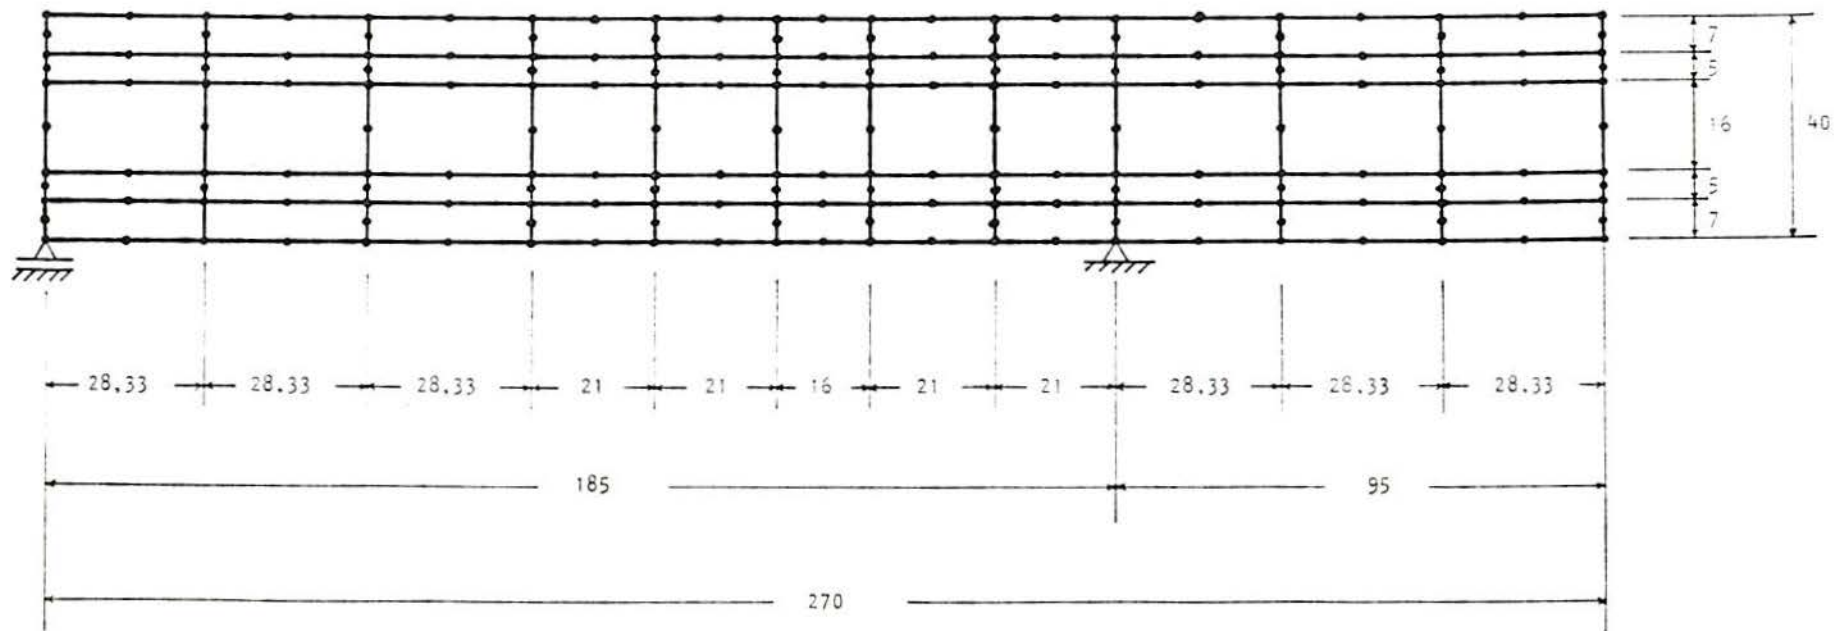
Discretização das vigas para a análise por elementos finitos
